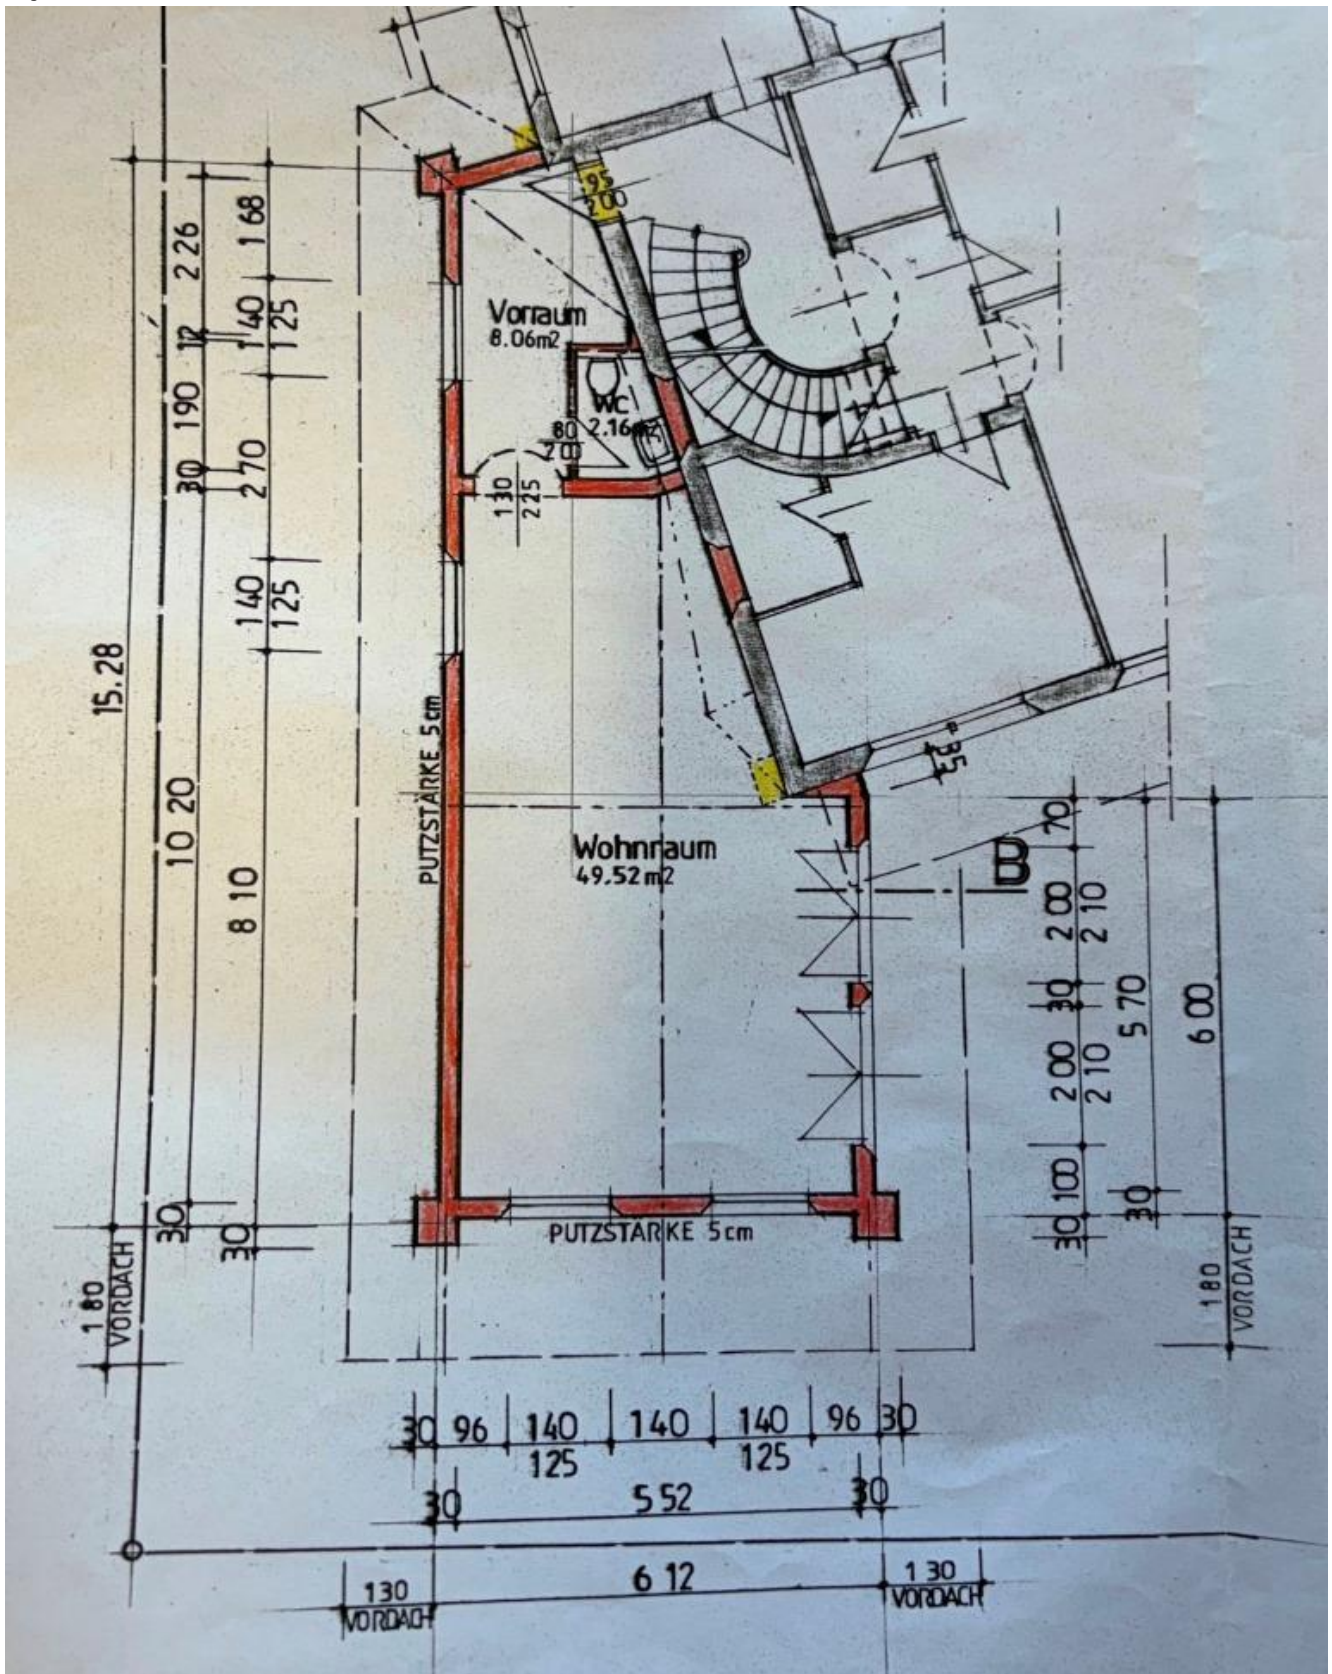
Grundriss Anbau 1998<sup>16</sup>
